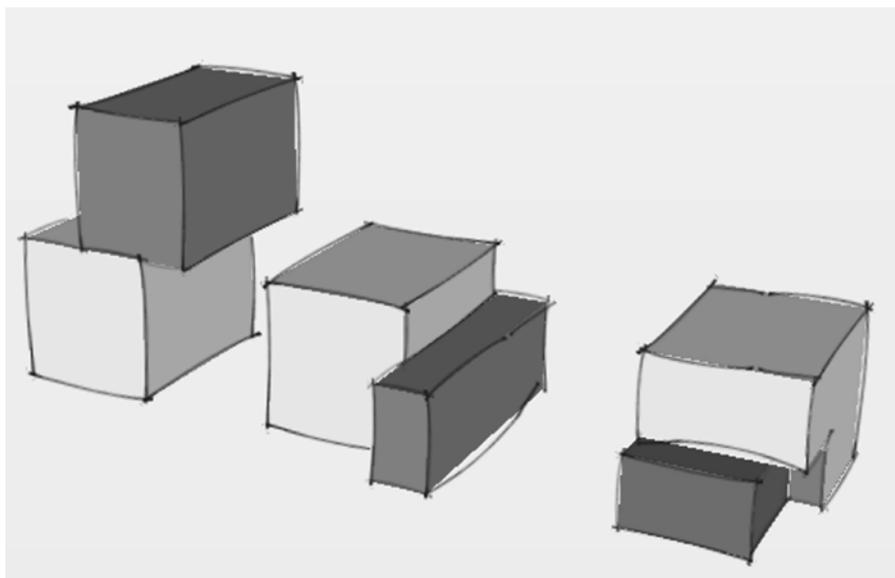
Schemi di addizione in copertura, facciata e piano pilotis
